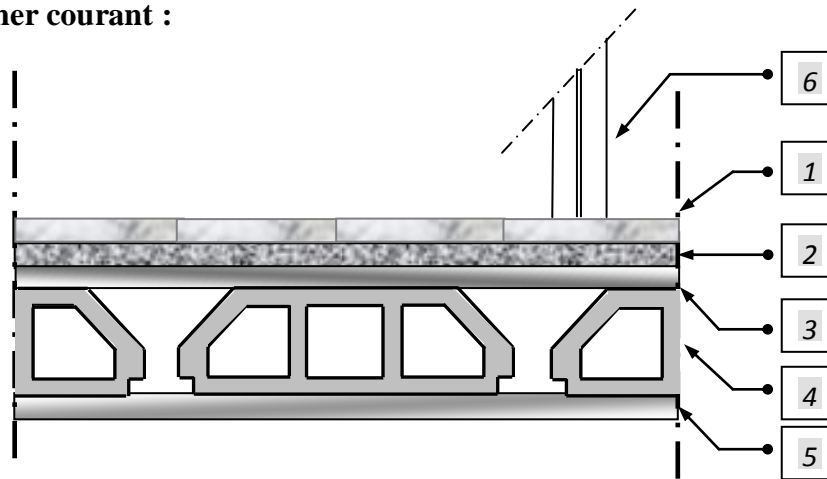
Coupe verticale du Plancher courant à corps creux.
